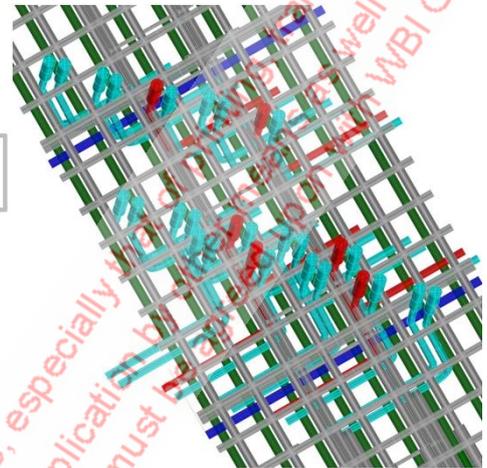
Bewehrung S-Bahn-Tunnel mit Anschluss an Sohle Fernbahntunnel
